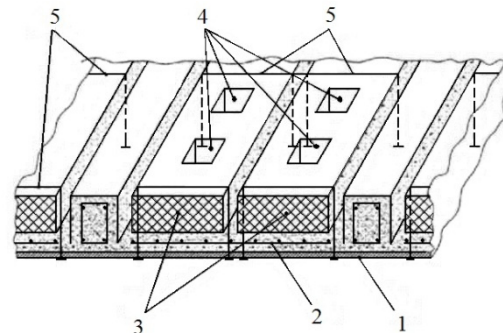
Схема фиксации вкладышей в облегченном перекрытии: 1 – опалубка; 2 – арматура нижней сетки; 3 – вкладыши; 4 – сквозные отверстия во вкладышах; 5 – металлические скобы
